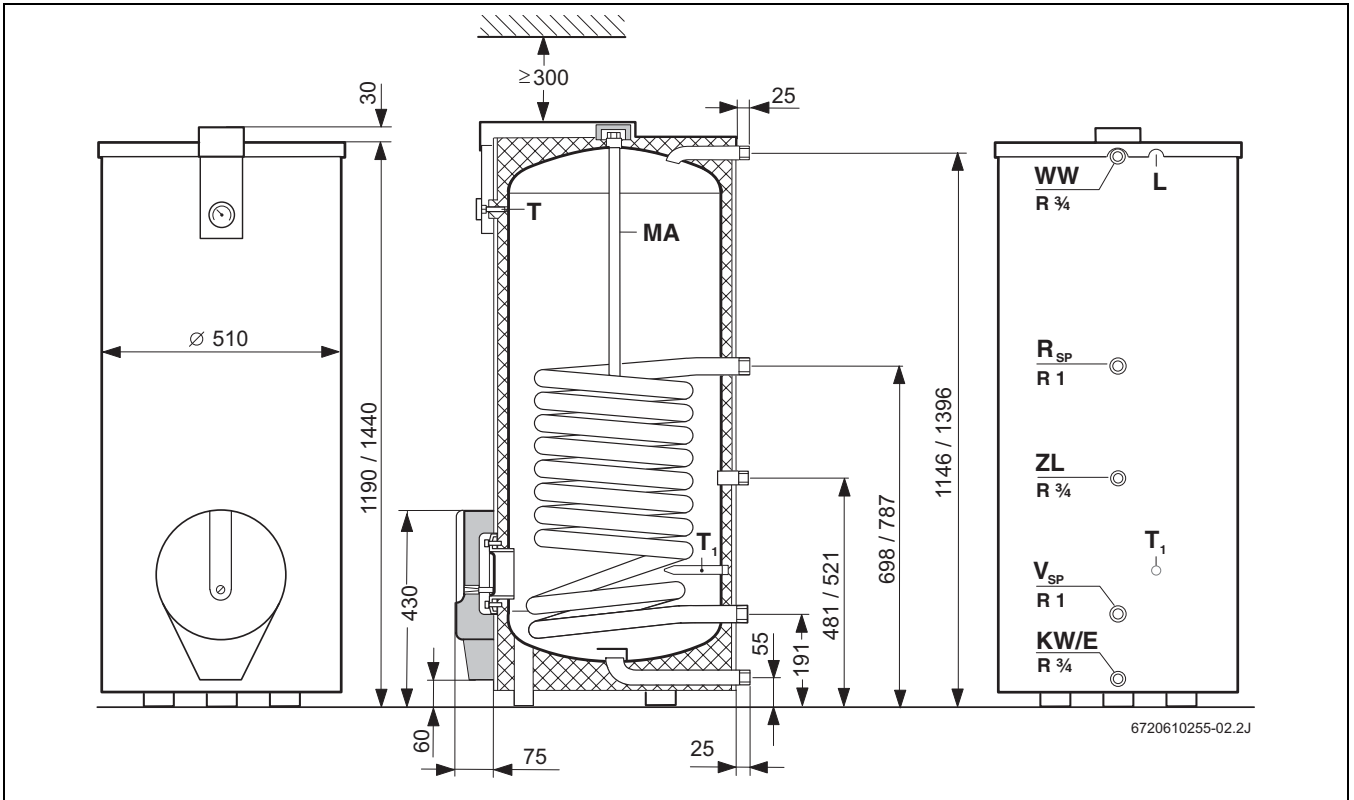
Bau- und Anschlussmaße SK 160/200-4 ZB
